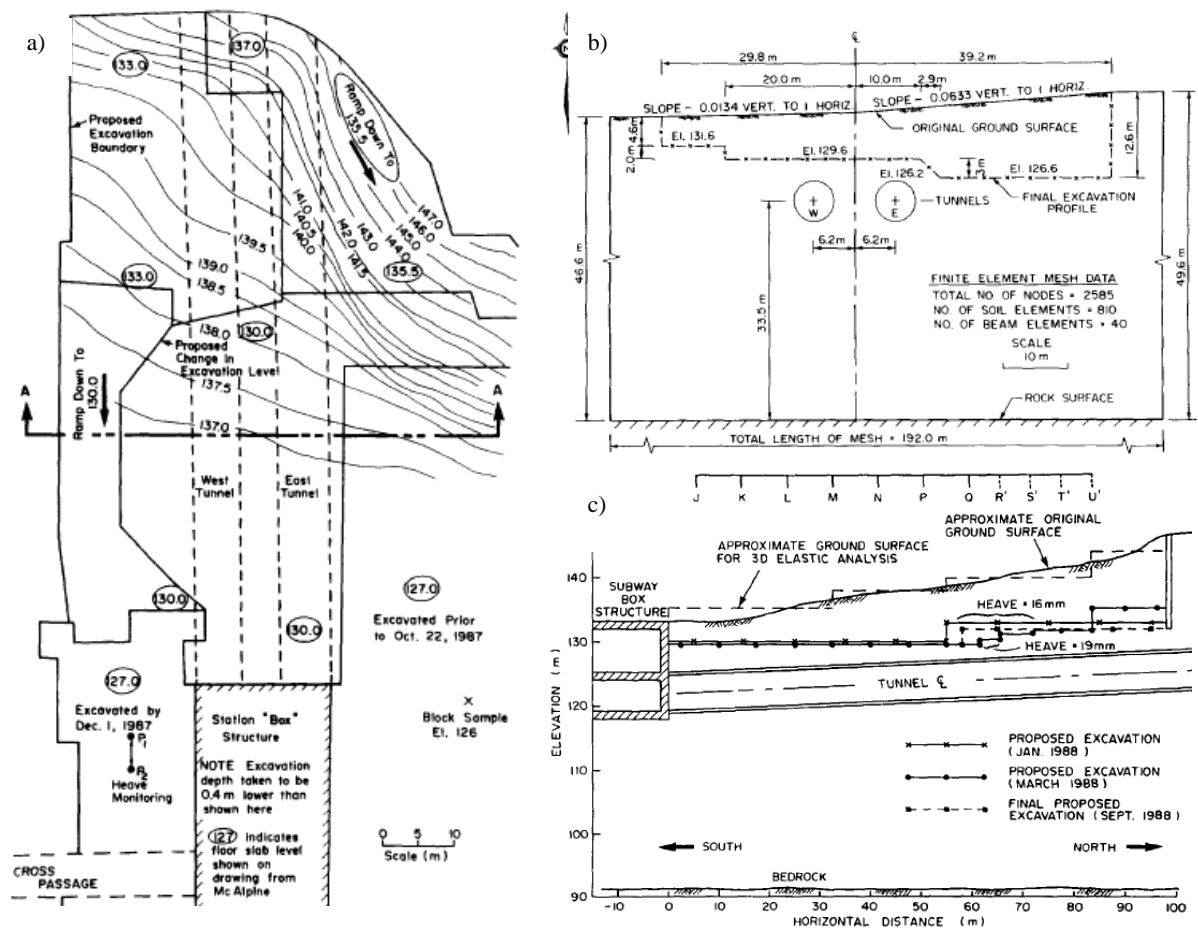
a) Planta esquemática, b) Secção A-A, c) Perfil Longitudinal (Lo & Ramsay, 1991).
